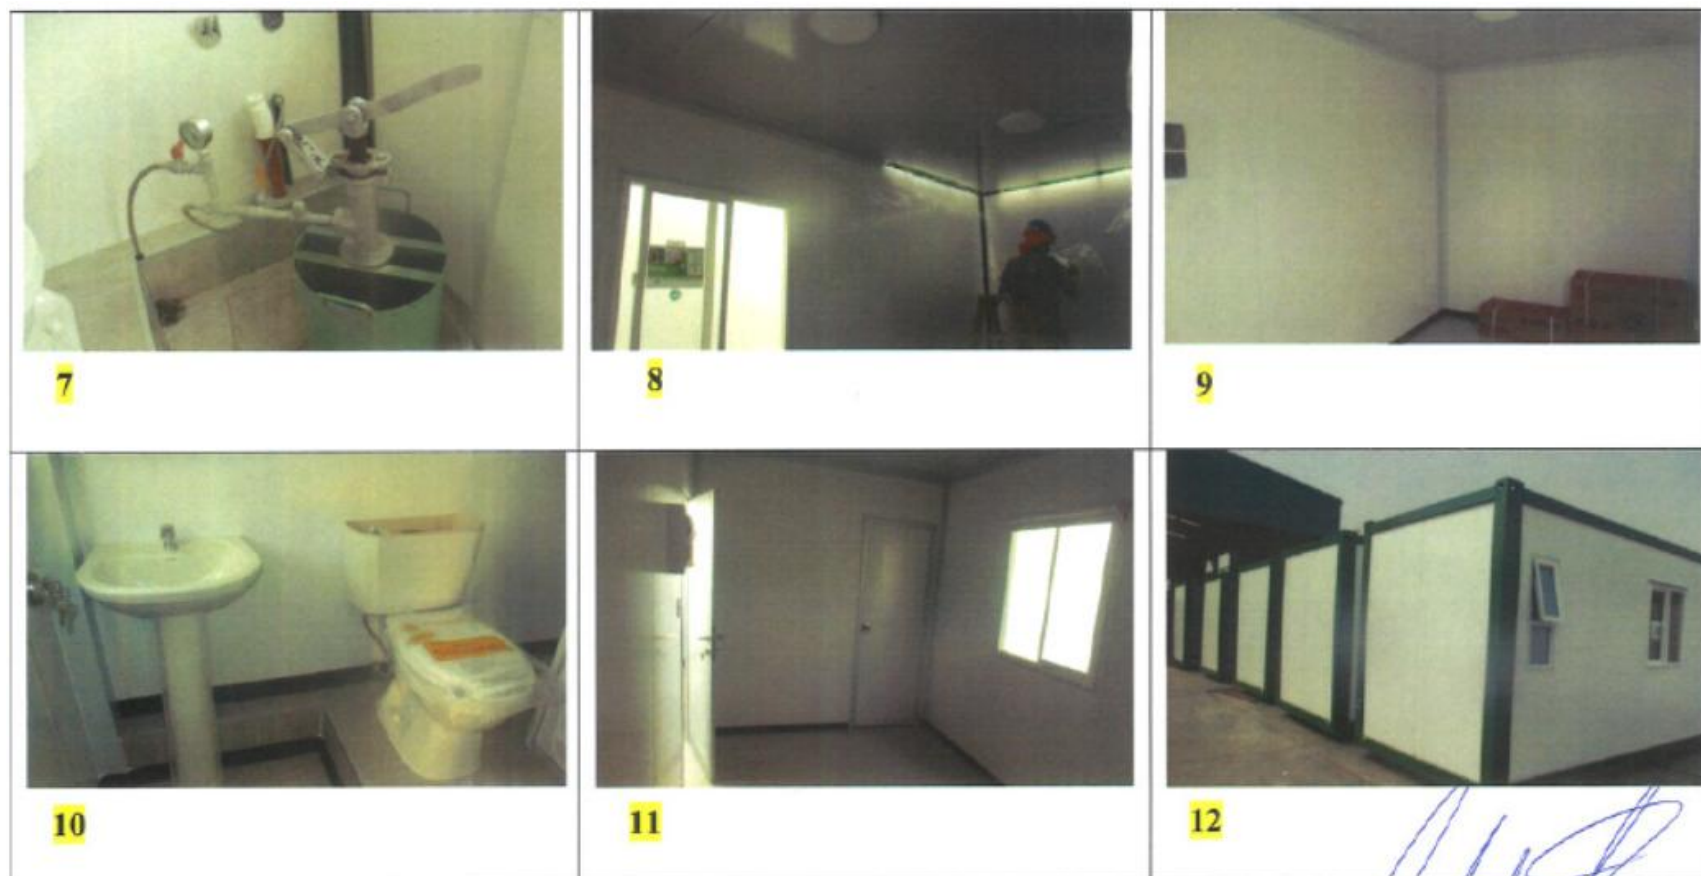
Inspección de panelizado y canalizado eléctrico
